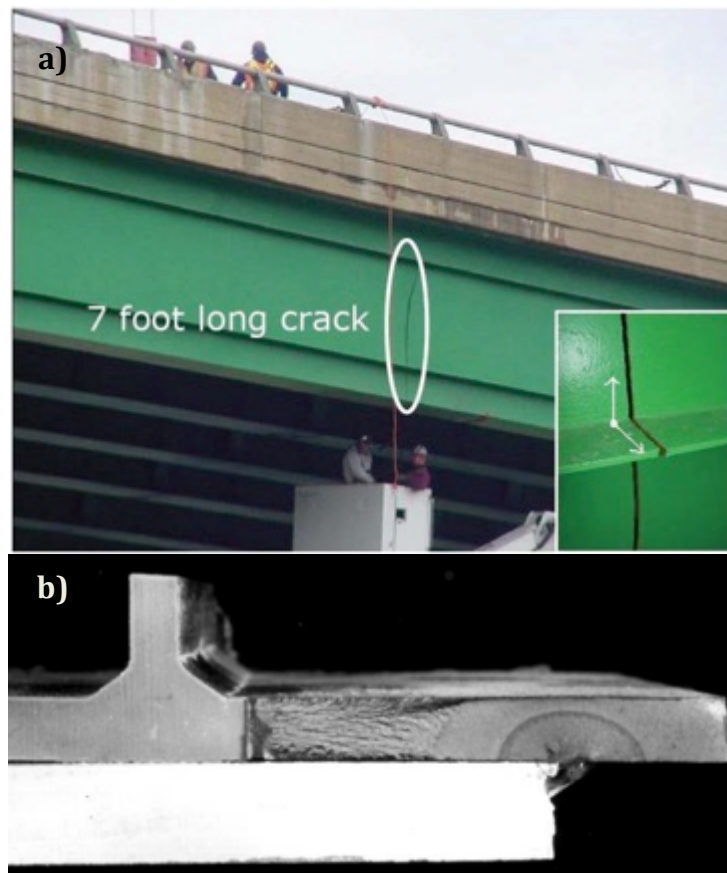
a) Fisura por fatiga originada en la soldadura de un cajón metálico [9];
